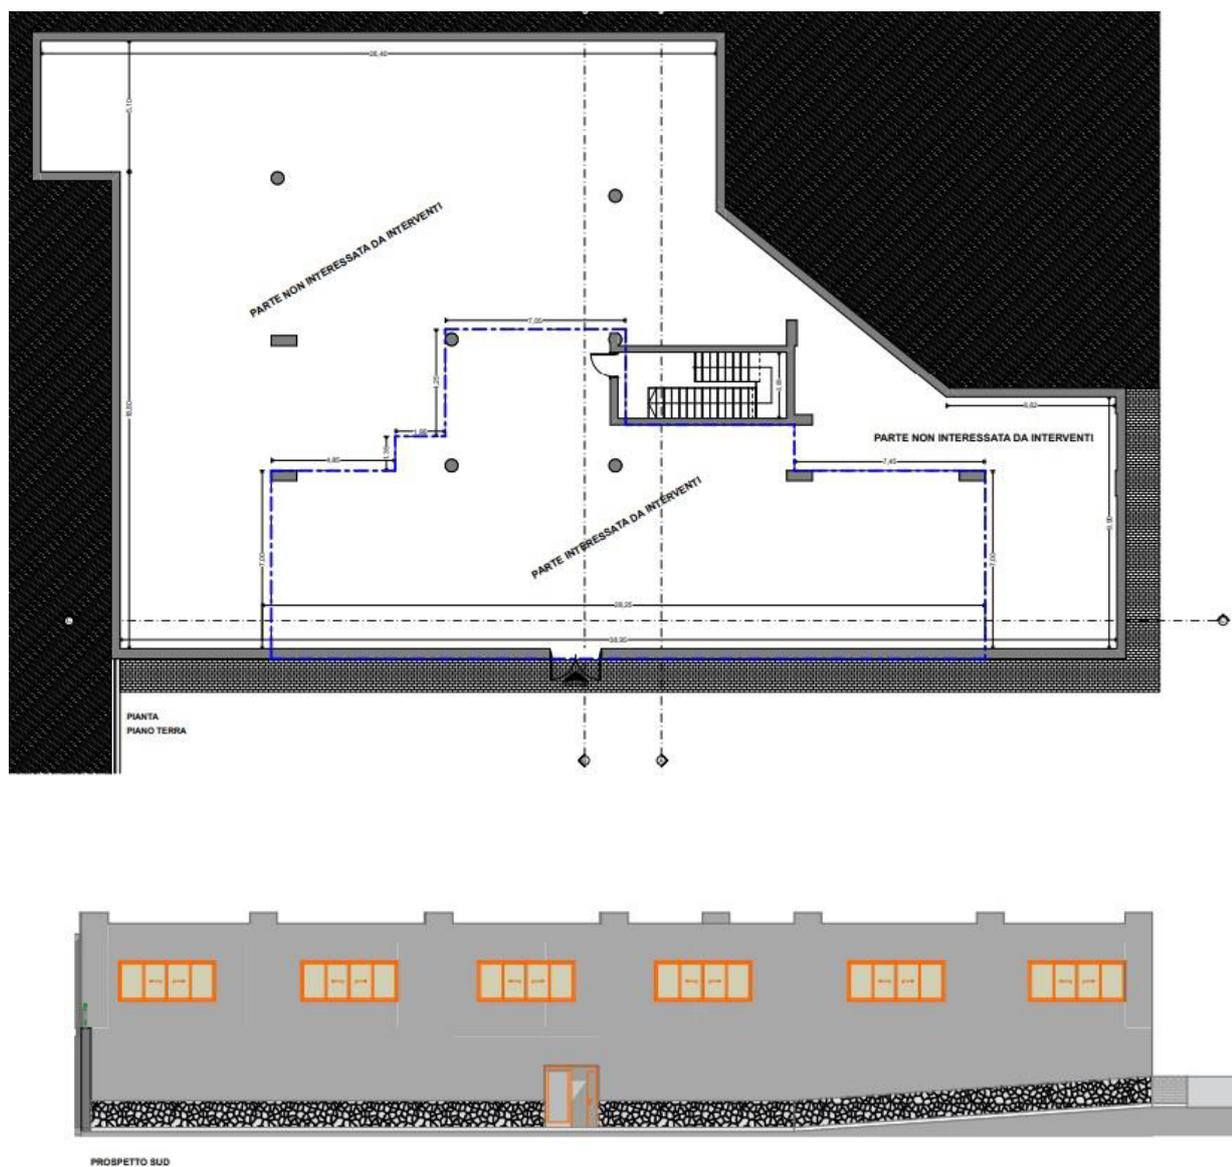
rappresentazioni grafiche della Planimetria e prospetto Sud dello stato attuale del Piano interrato istituto scolastico F. Filzi
